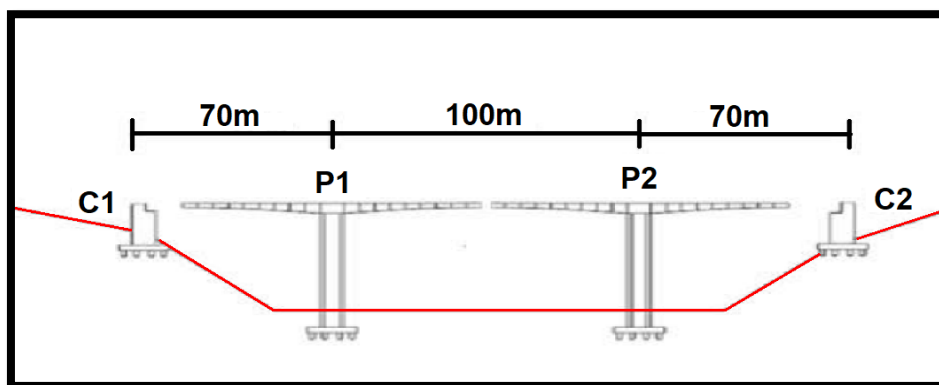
phase N°1 : Construction de fléau sur pile
